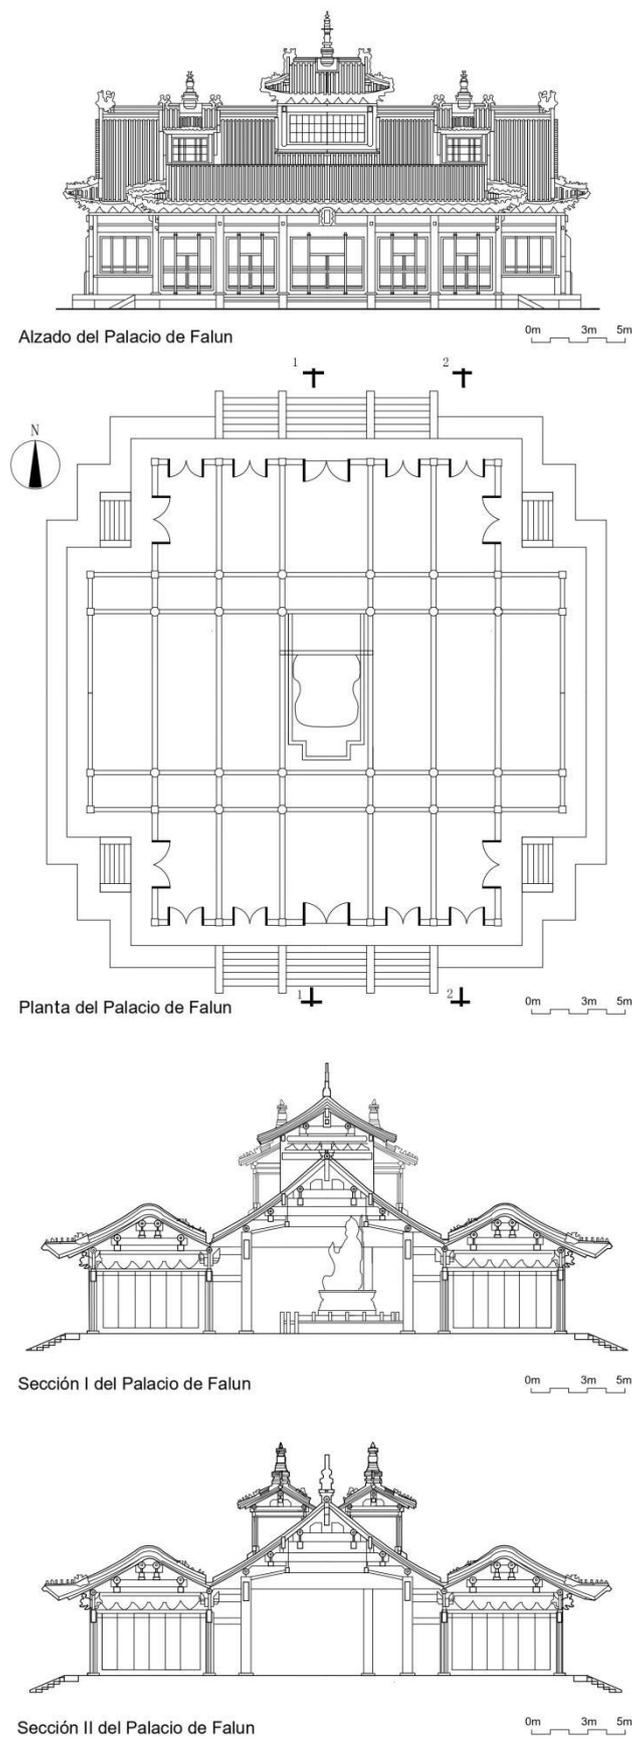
Alzado, planta y secciones del Palacio de Falun. Propia. Basado en Li, 2007.
